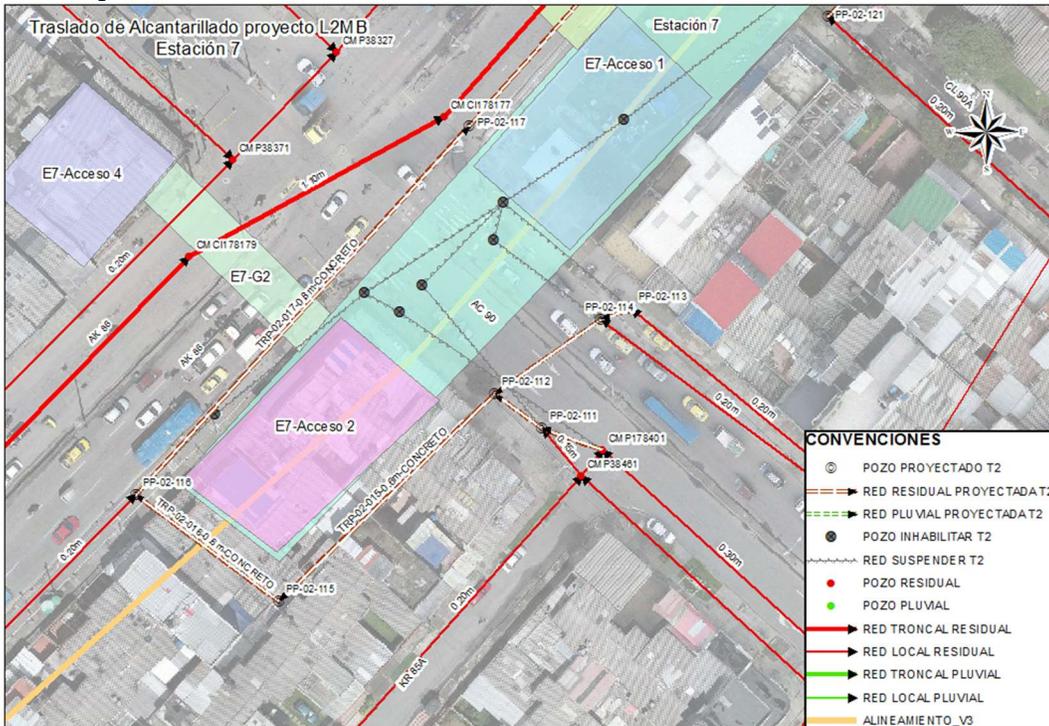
Traslado redes de alcantarillado Estación 7 Carrera 86 con calle 90 Red Residual
